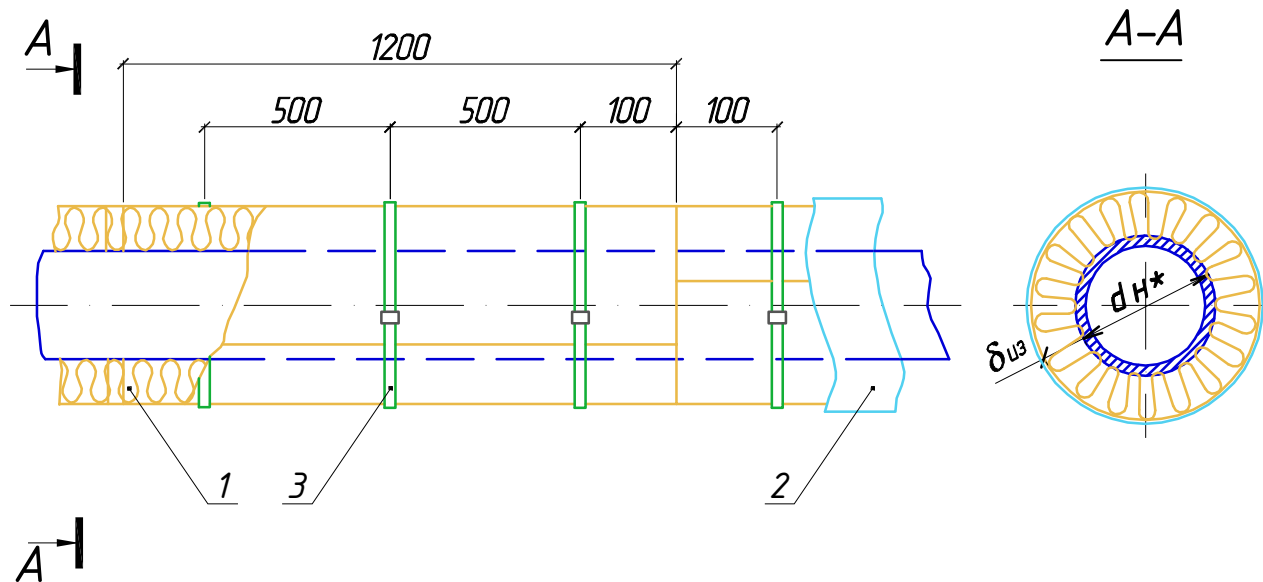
Изоляция вертикальных трубопроводов с наружным диаметром теплоизоляционной конструкции не более 200 мм матами ТЕХНОНИКОЛЬ 40
